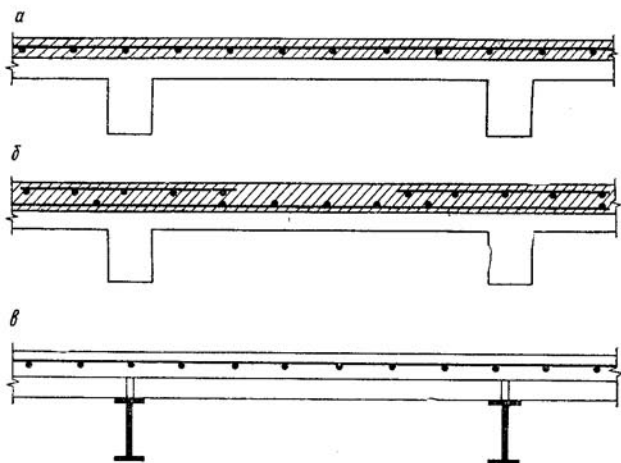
Способы усиления железобетонных плит наращиванием
